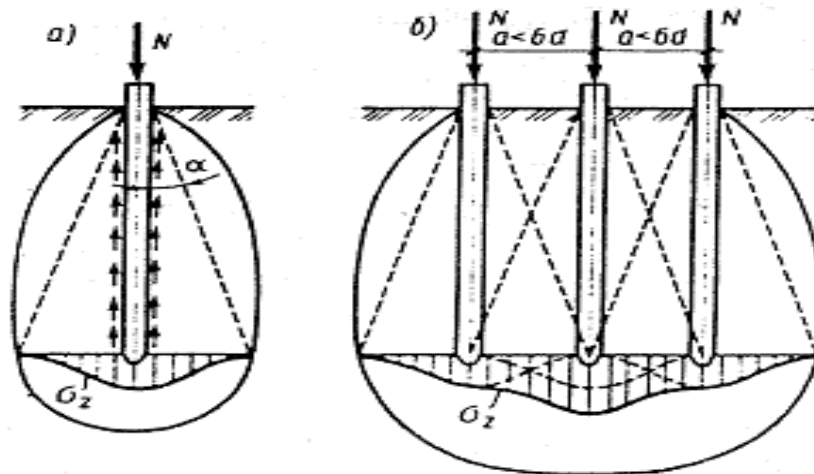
Схеми передачі навантаження на ґрунт основи:
